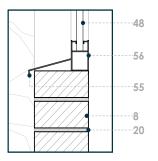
Detalle D-07 Esc 1:10. Fuente: Autores, 2024
